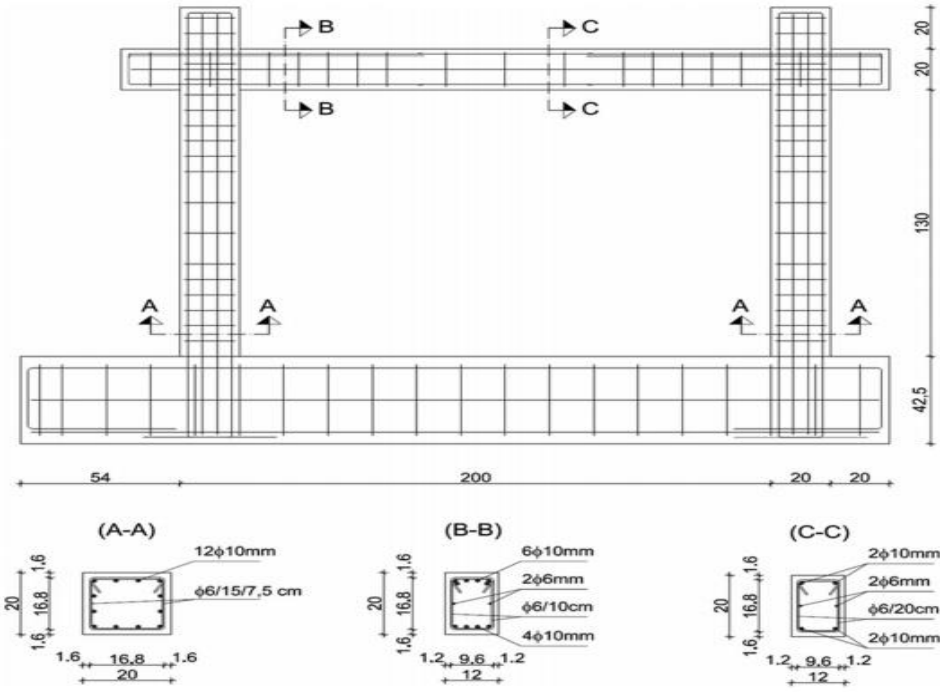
Muestras ensayadas y características del marco de hormigón armado
